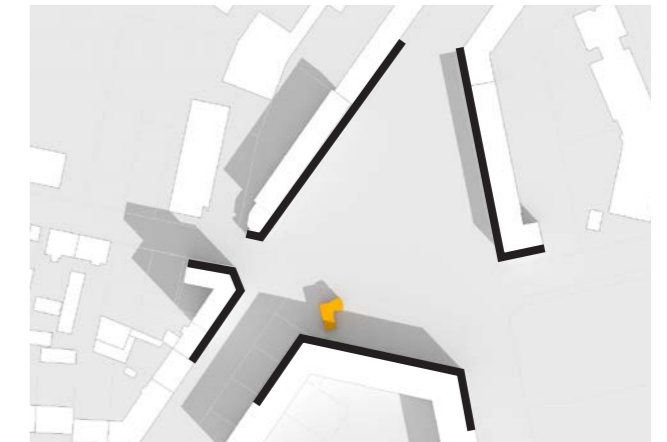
Variante 1 - Umgang mit dem Pfortnerhaus
